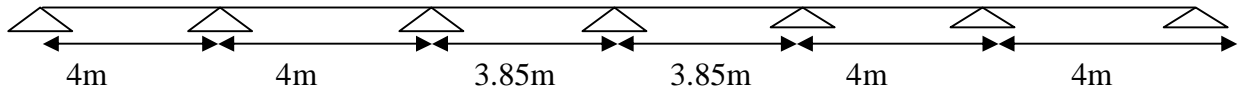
disposition des poutrelles d'étage d'habitation.
